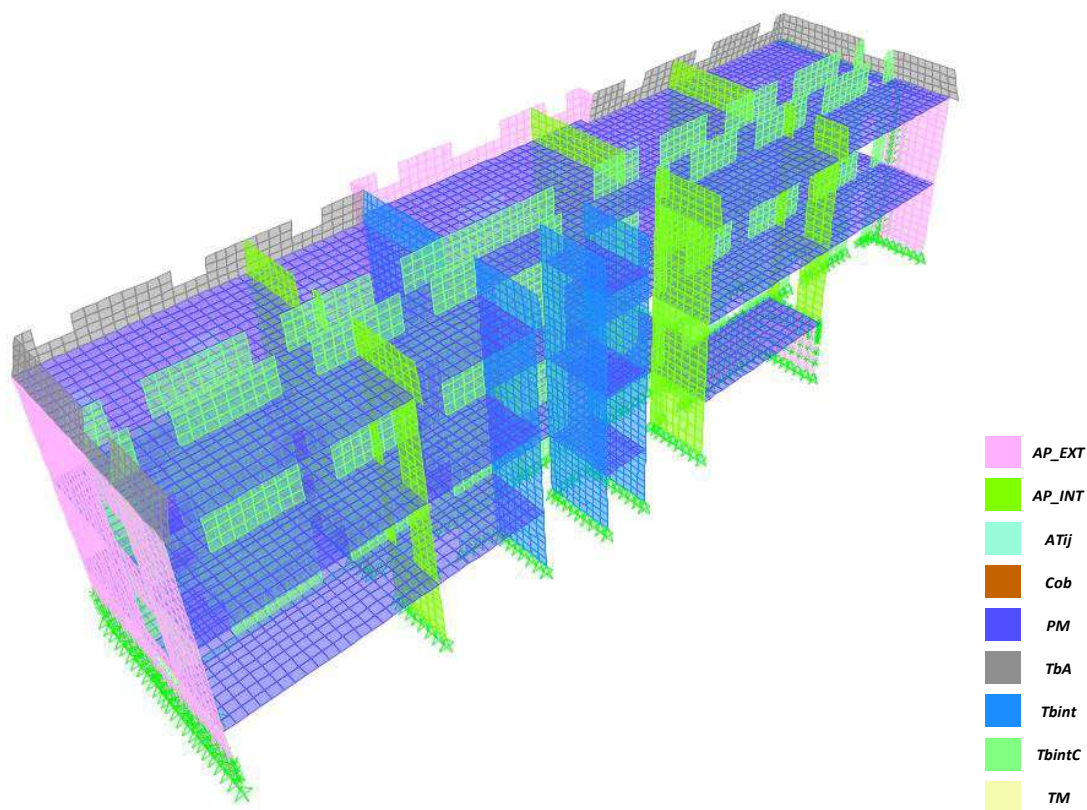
Perspetiva com um corte longitudinal e outro paralelo ao plano do pavimento no piso de mansarda.
